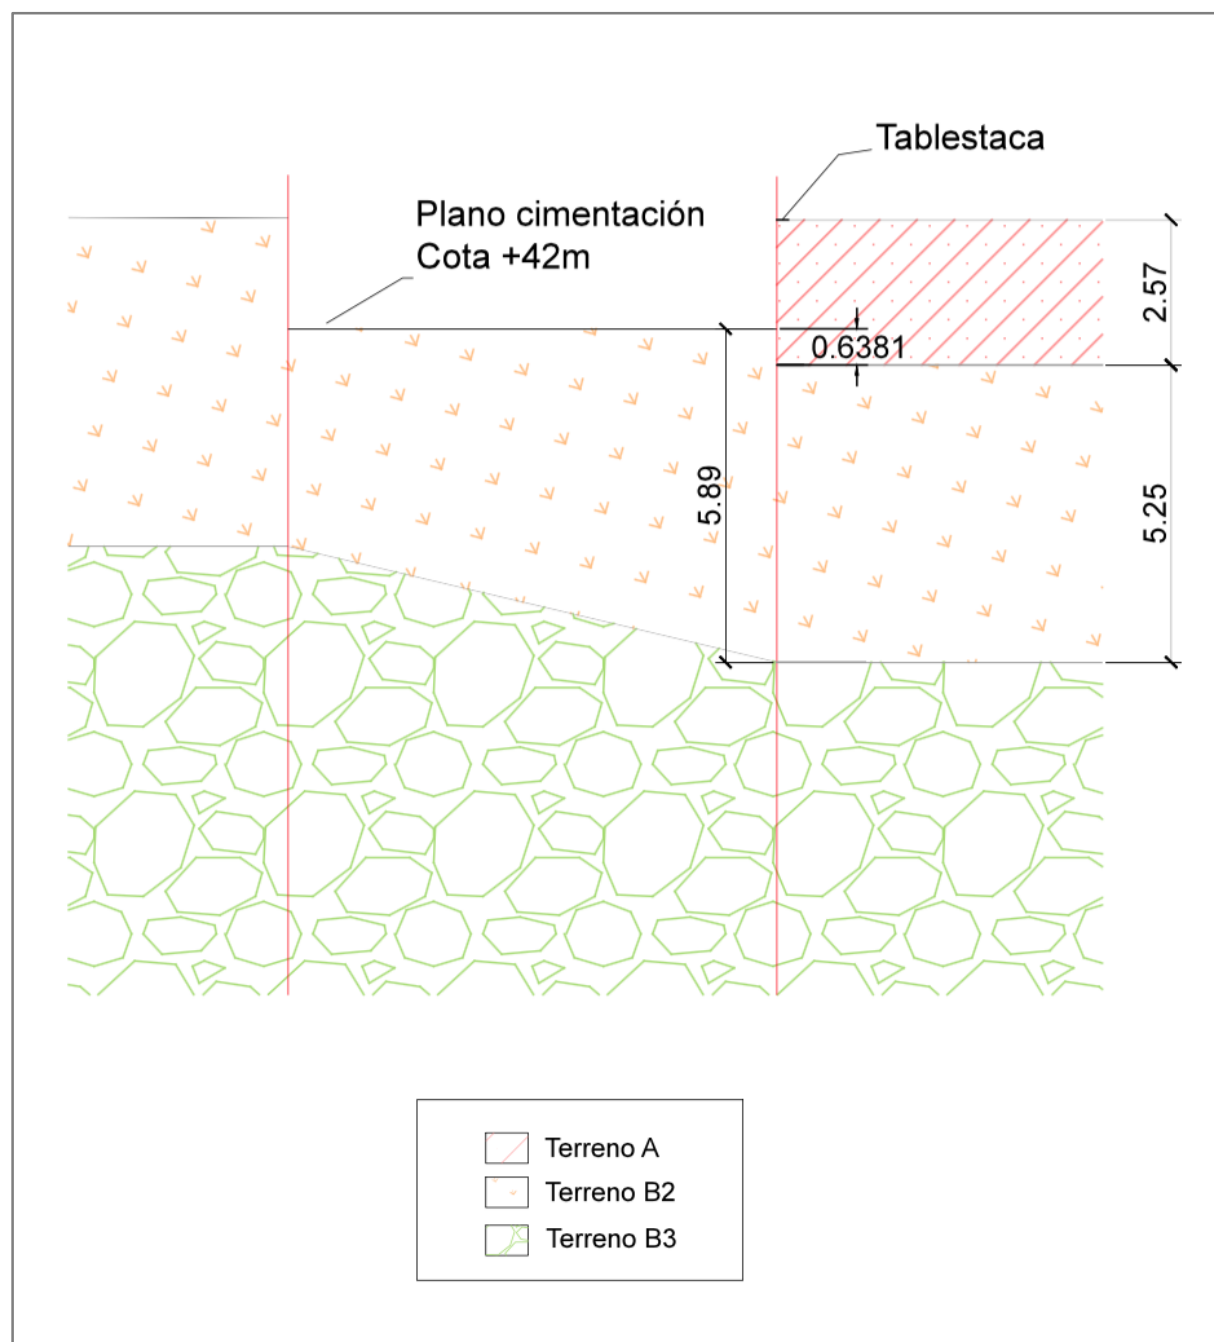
Terreno en el estribo norte para excavación sin acodalamiento.
